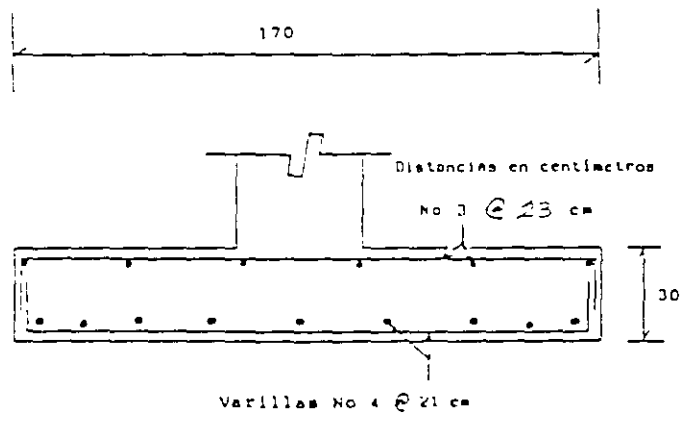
CARACTERISTICAS ESTRUCTURALES DE LA ZAPATA (EJEMPLO 5.6)
